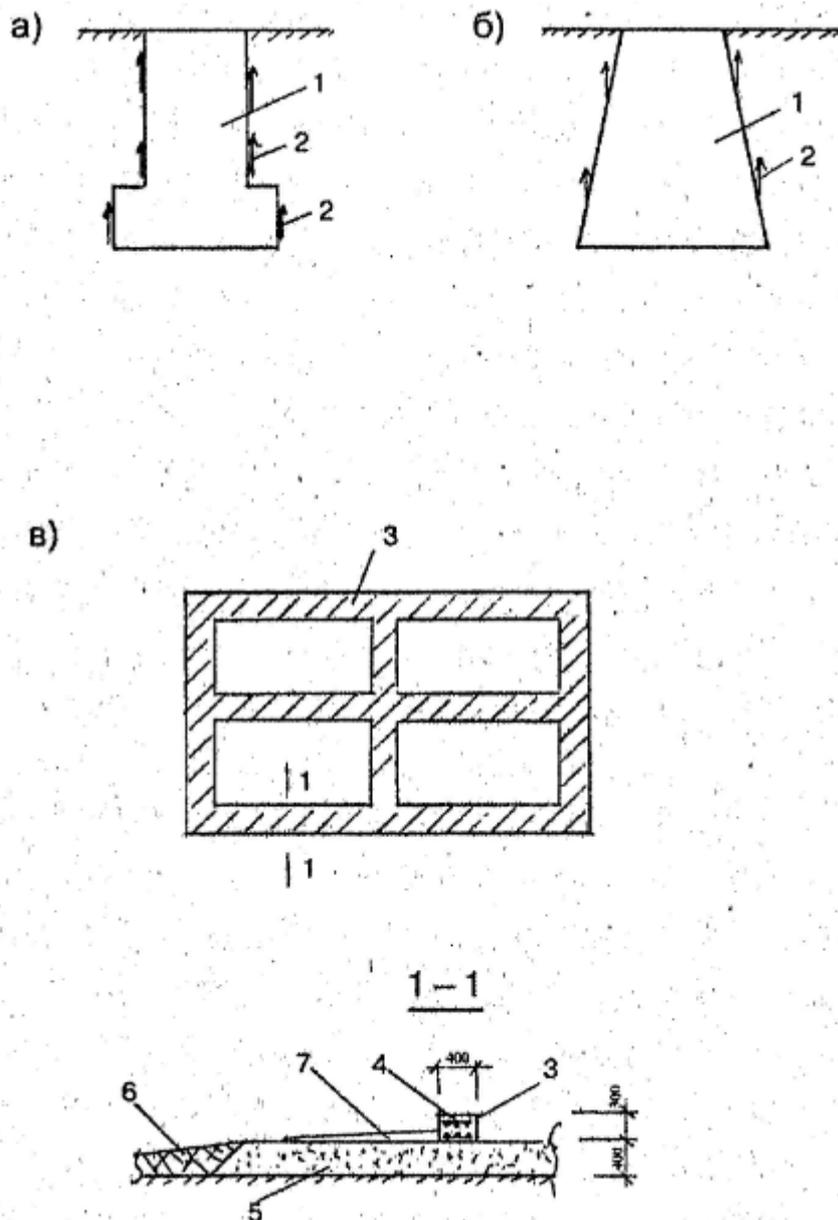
Фундаменты на пучинистых грунтах: а – неблагоприятная форма фундамента; б – благоприятная форма; в – рекомендуемый фундамент для легкого одно-двухэтажного здания; 1 – фундамент; 2 – силы от пучения грунта; 3 – ленточный фундамент; 4 – арматурный каркас; 5 – песчаная подушка; 6 – дерновый слой грунта; 7 - отмостка
